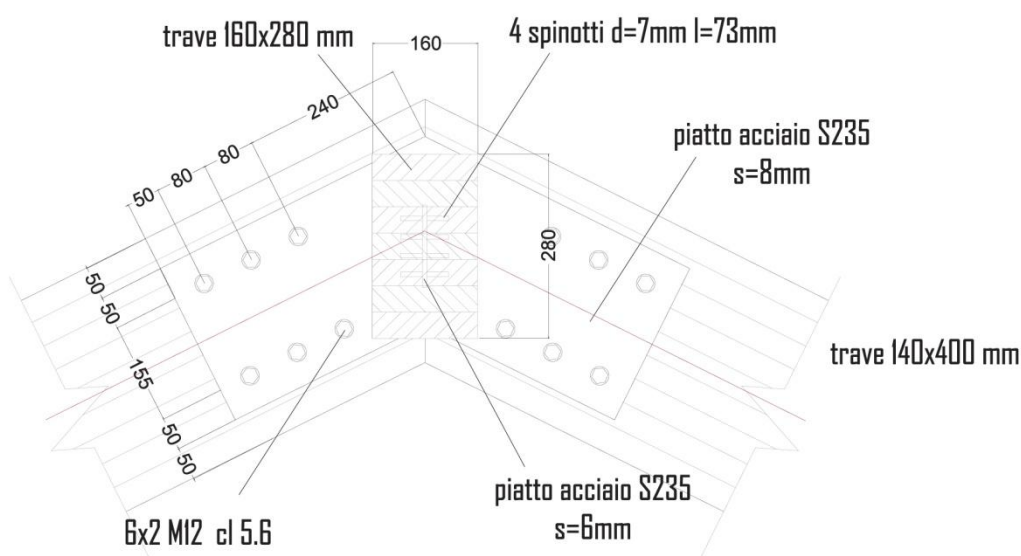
Collegamento trave di copertura-trave di colmo
